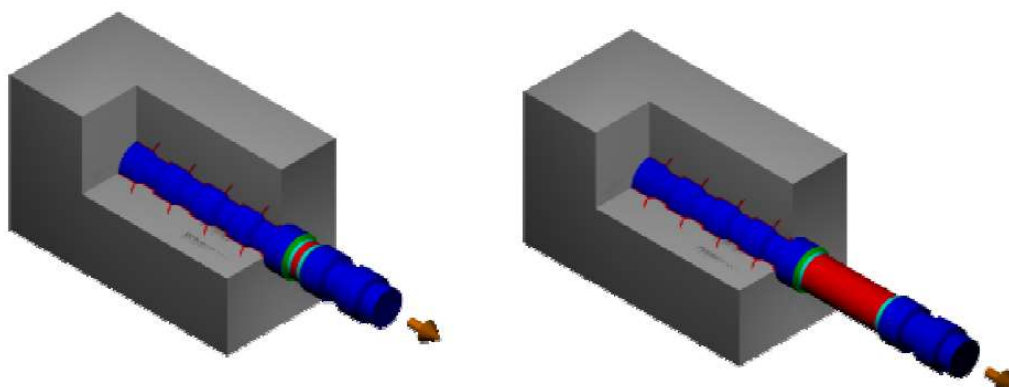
Rotura por plastificação da armadura, adaptado de [39].
